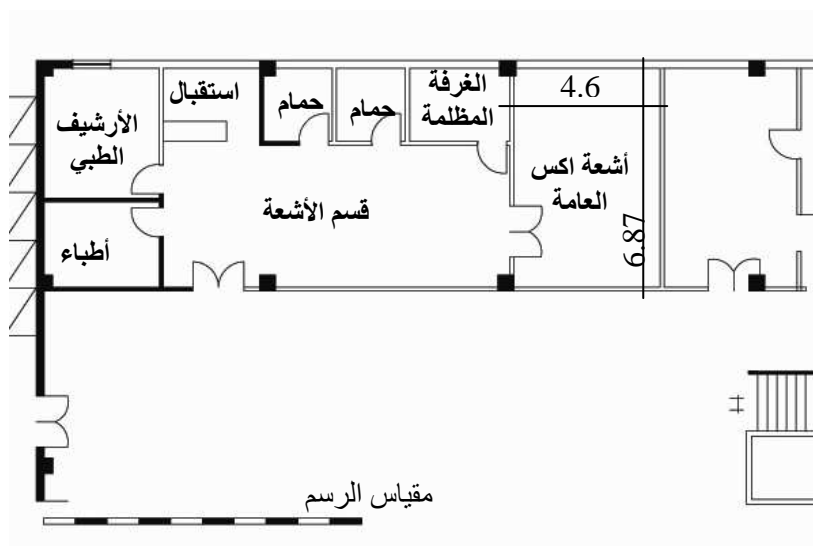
المسقط الأفقي للدور الأرضي لمستشفى الأقصر العام قبل التطوير
